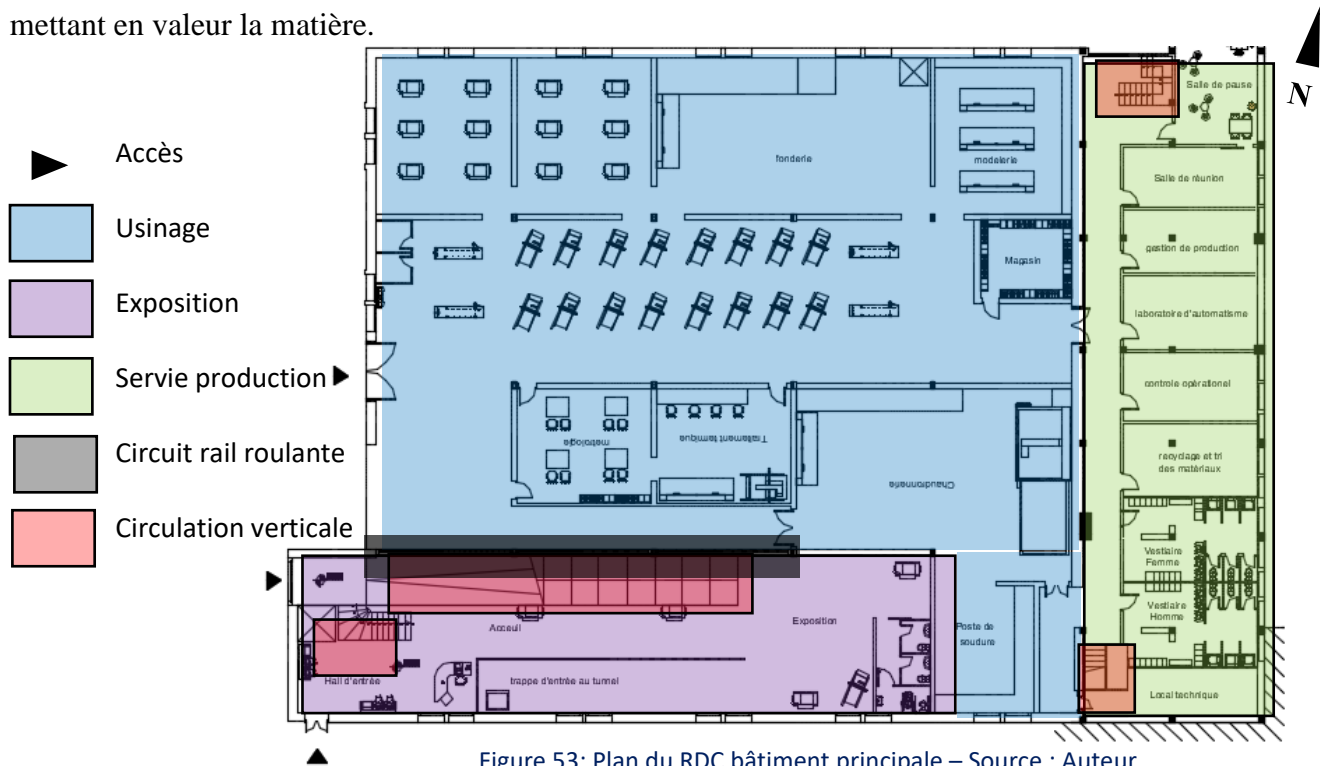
Plan du RDC bâtiment principale – Source : Auteur
